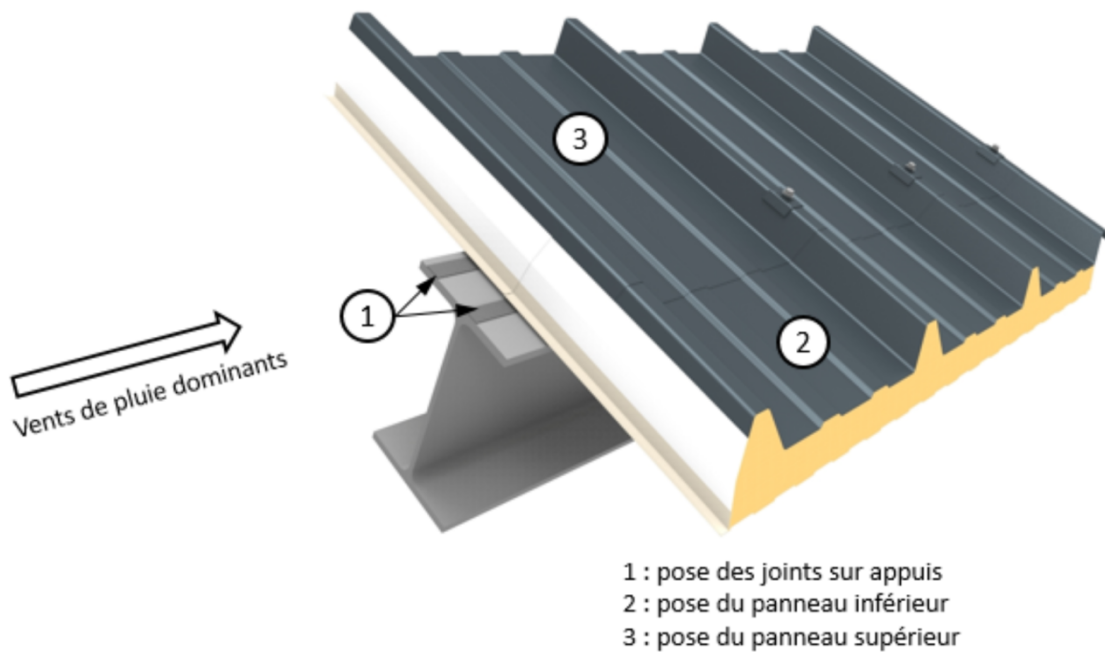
Détail sur appui – Joints sur appuis au droit d'un recouvrement transversal de panneaux sans complément d'étanchéité (CE) – locaux à faible ou moyenne hygrométrie (cf. §2.4.4)
